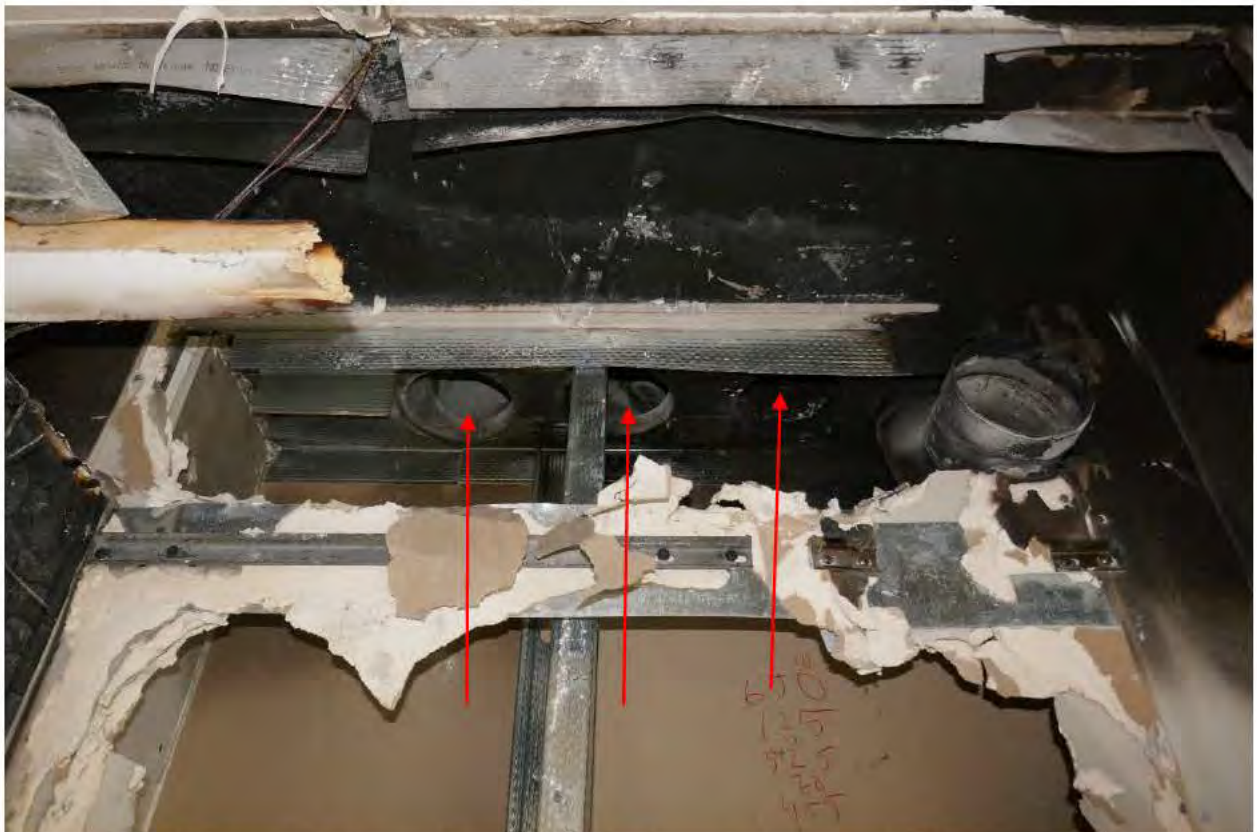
Ventilationsschaktet ovanför spisen, vid pilarna är det tre vertikala genomföringar genom betongplattan. Till höger syns ventilationsröret ifrån den drabbade lägenheten som går vidare genom betongbjälklaget.
